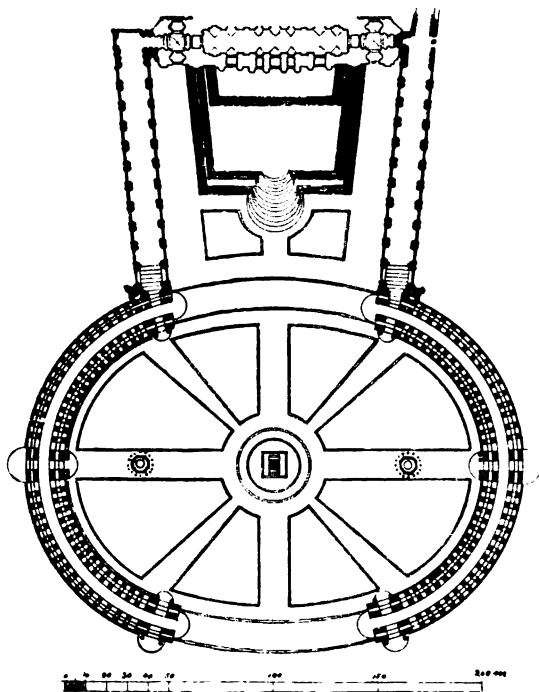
Kolonnaden von St. Peter in Rom. Grundriss.
